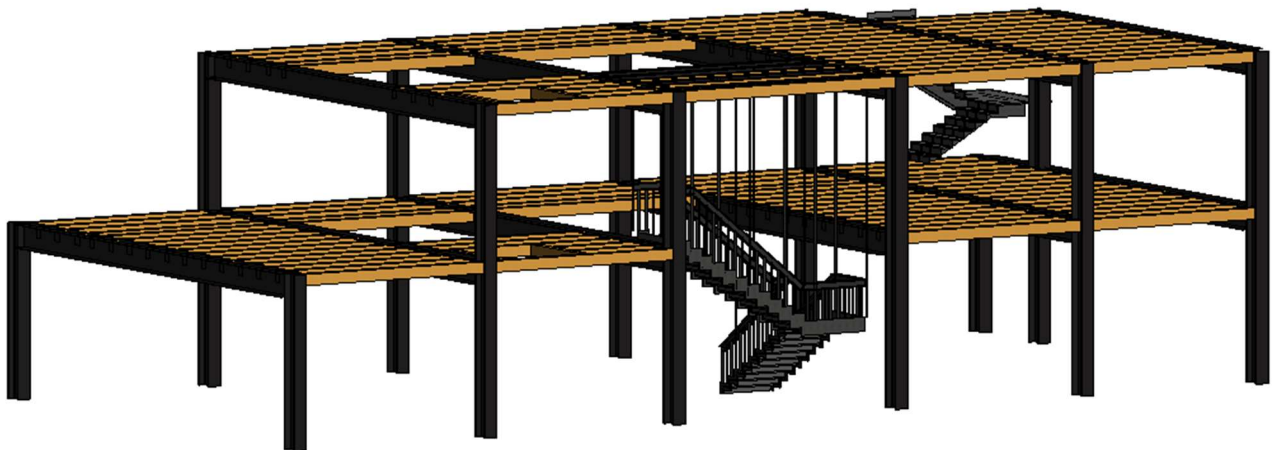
Vista tridimensionale della struttura portante con le scale, documento dell'autore
